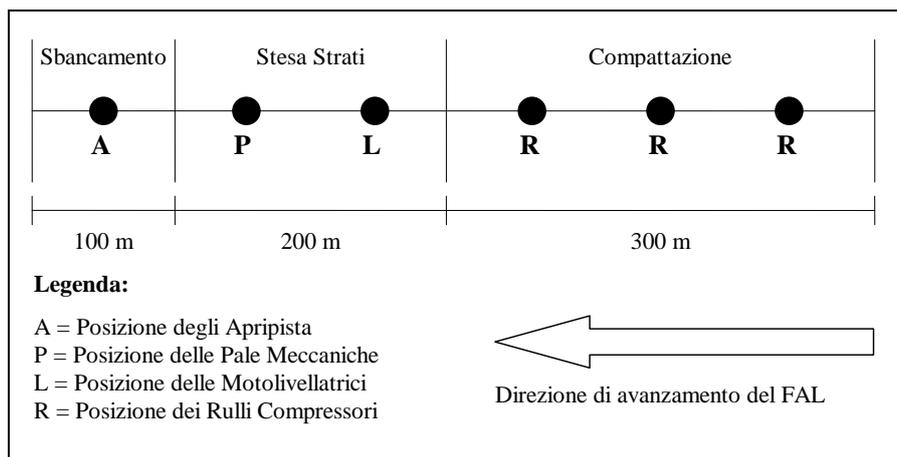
SCHEMA DI COSTRUZIONE TIPOLOGIA RILEVATO
